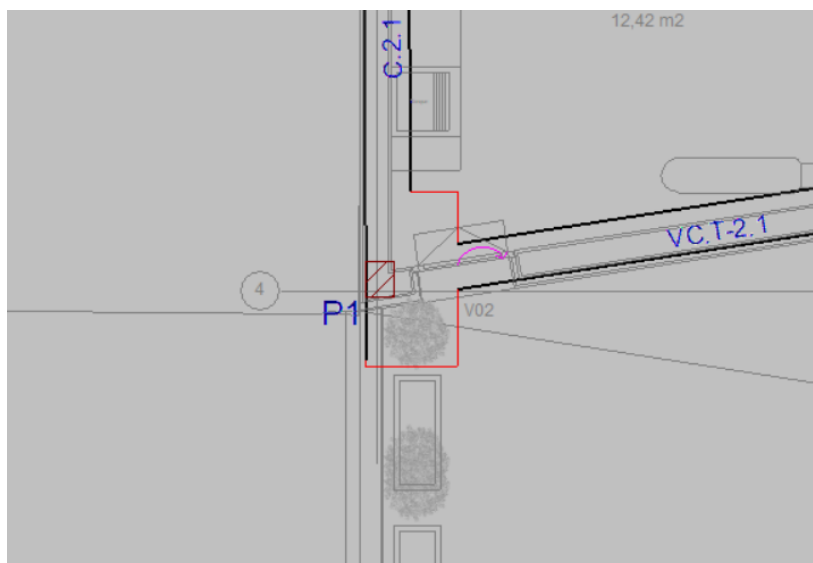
Fundação do Pilar P1 (Fonte: CYPE)
